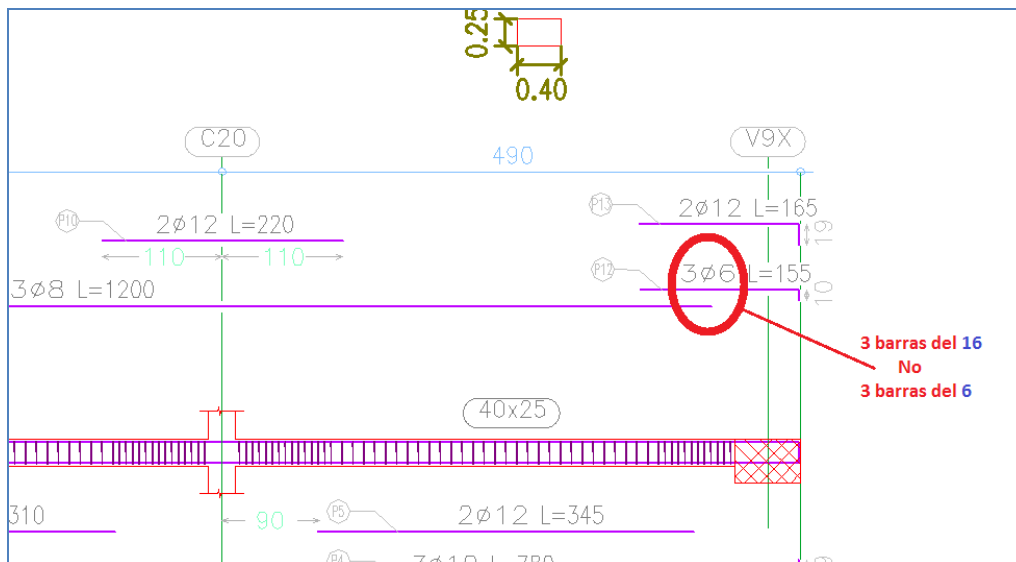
Detalle de armado de la viga V1Y en donde se destaca el error de tipeo.
